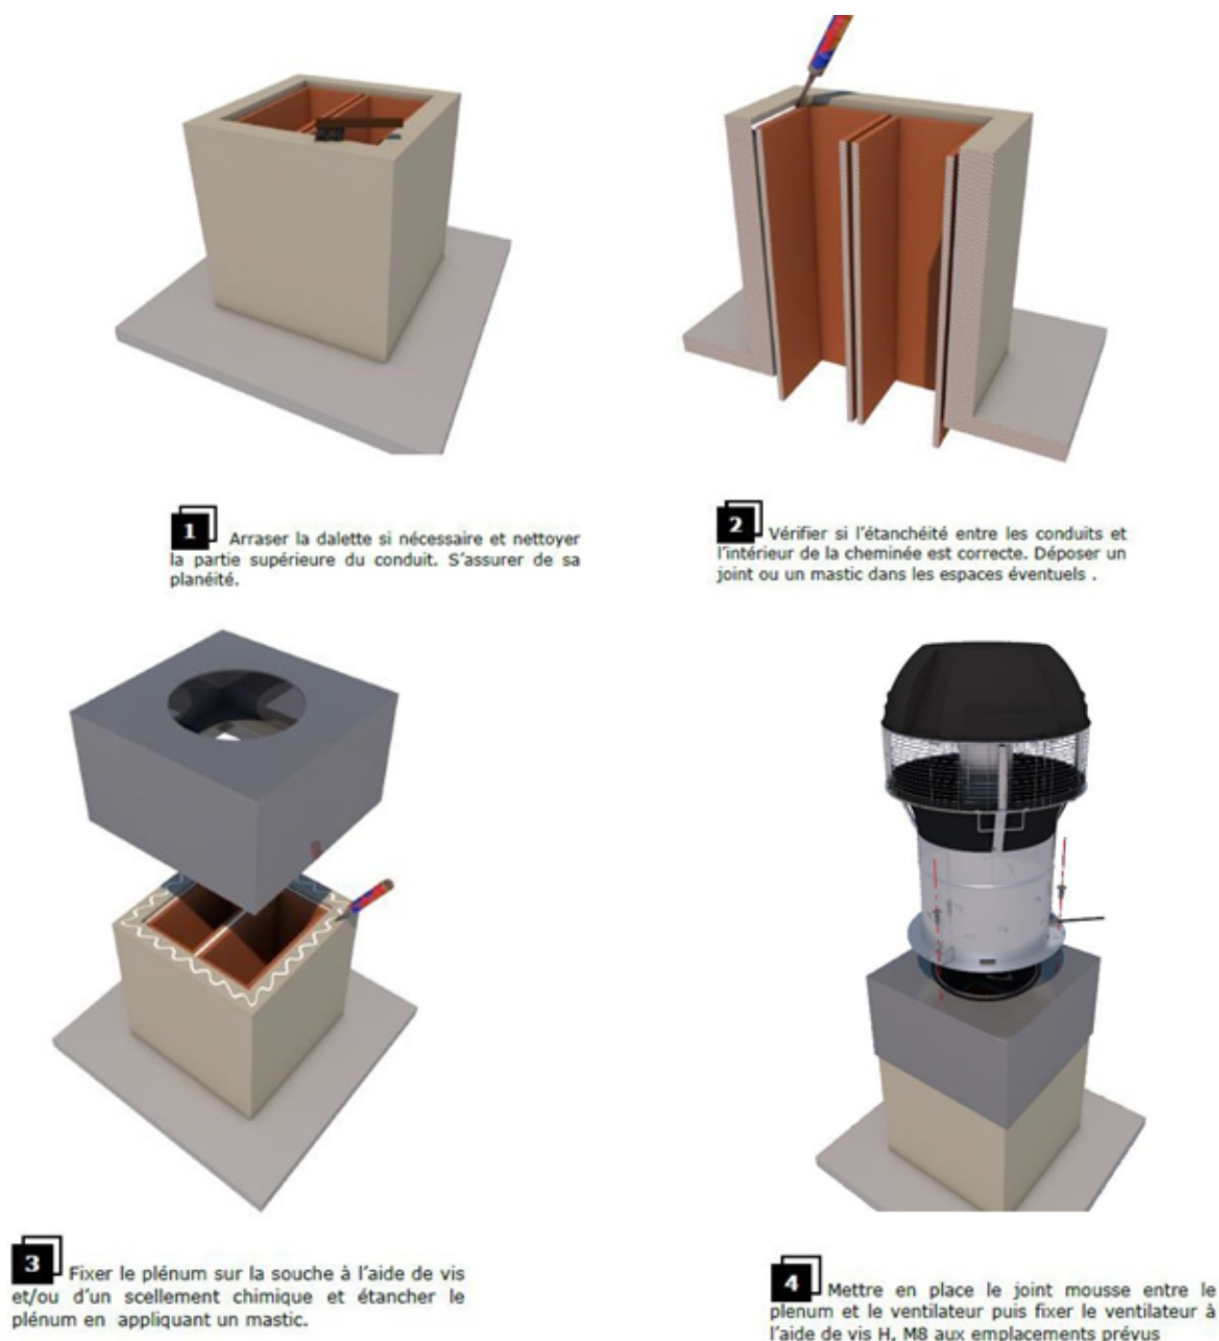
Mise en œuvre du ventilateur - Cas d'un conduit existant avec dalle supprimée
